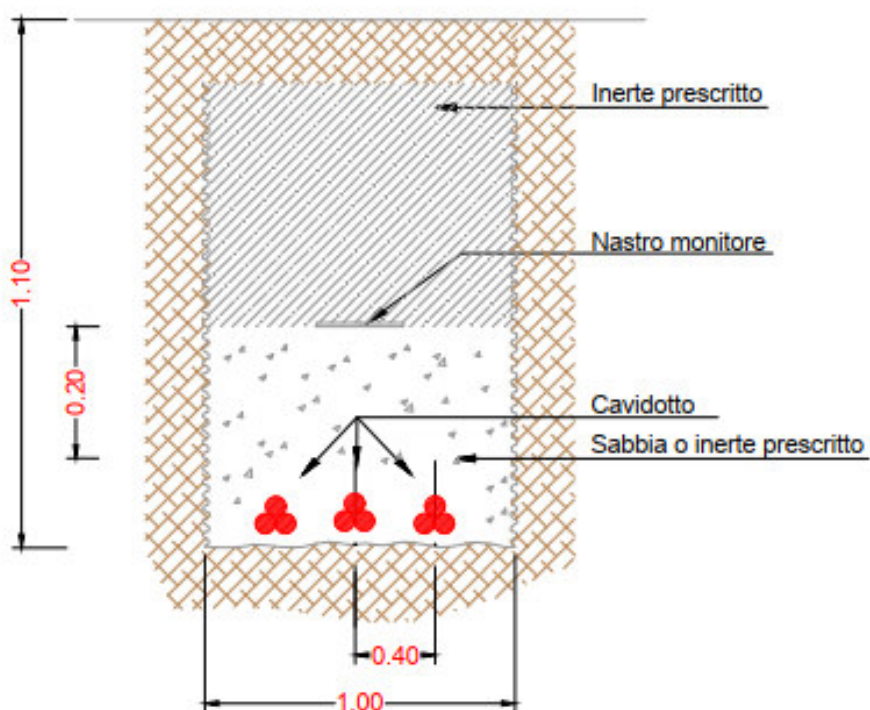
Posa tipo bordo strada (da tav. PA-Tav.12.6)
